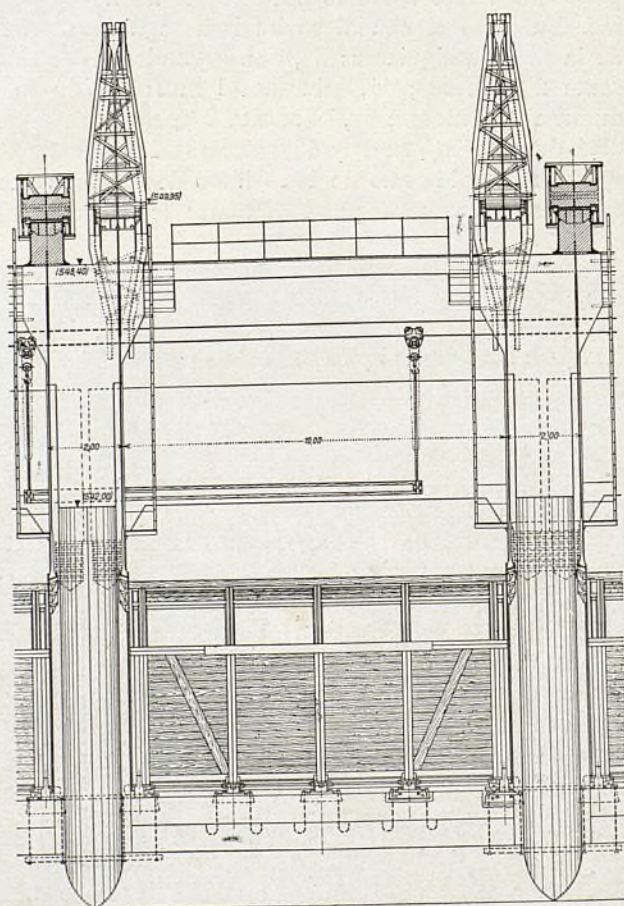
Corte y fig. 15 vista desde aguas abajo de una de las compuertas automáticas con doble palanca y contrapeso de hormigón 1:200. Apoyo de las dobles palancas sobre apoyos en forma de consola, construidos encima las cabezas de los pilares. Vía suspendida para el transporte de los durmientes de las compuertas.
